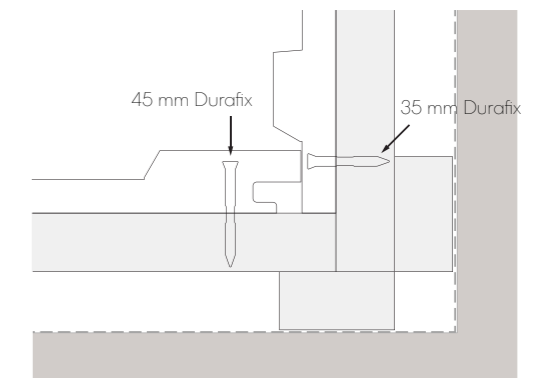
Details der auf Gehrung geschnittenen Innenecke
